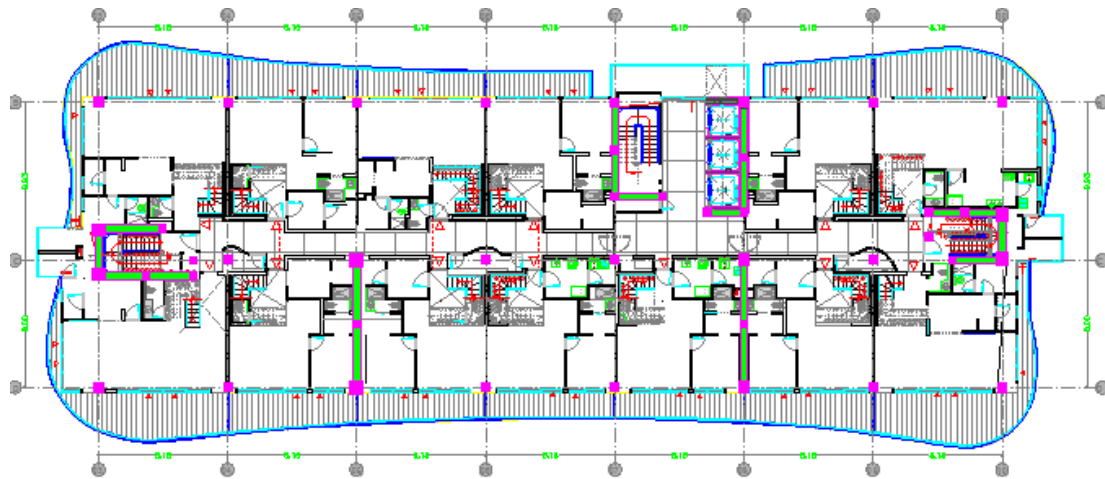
Planta de viviendas, columnas (lila) y arriostramientos (verde).
